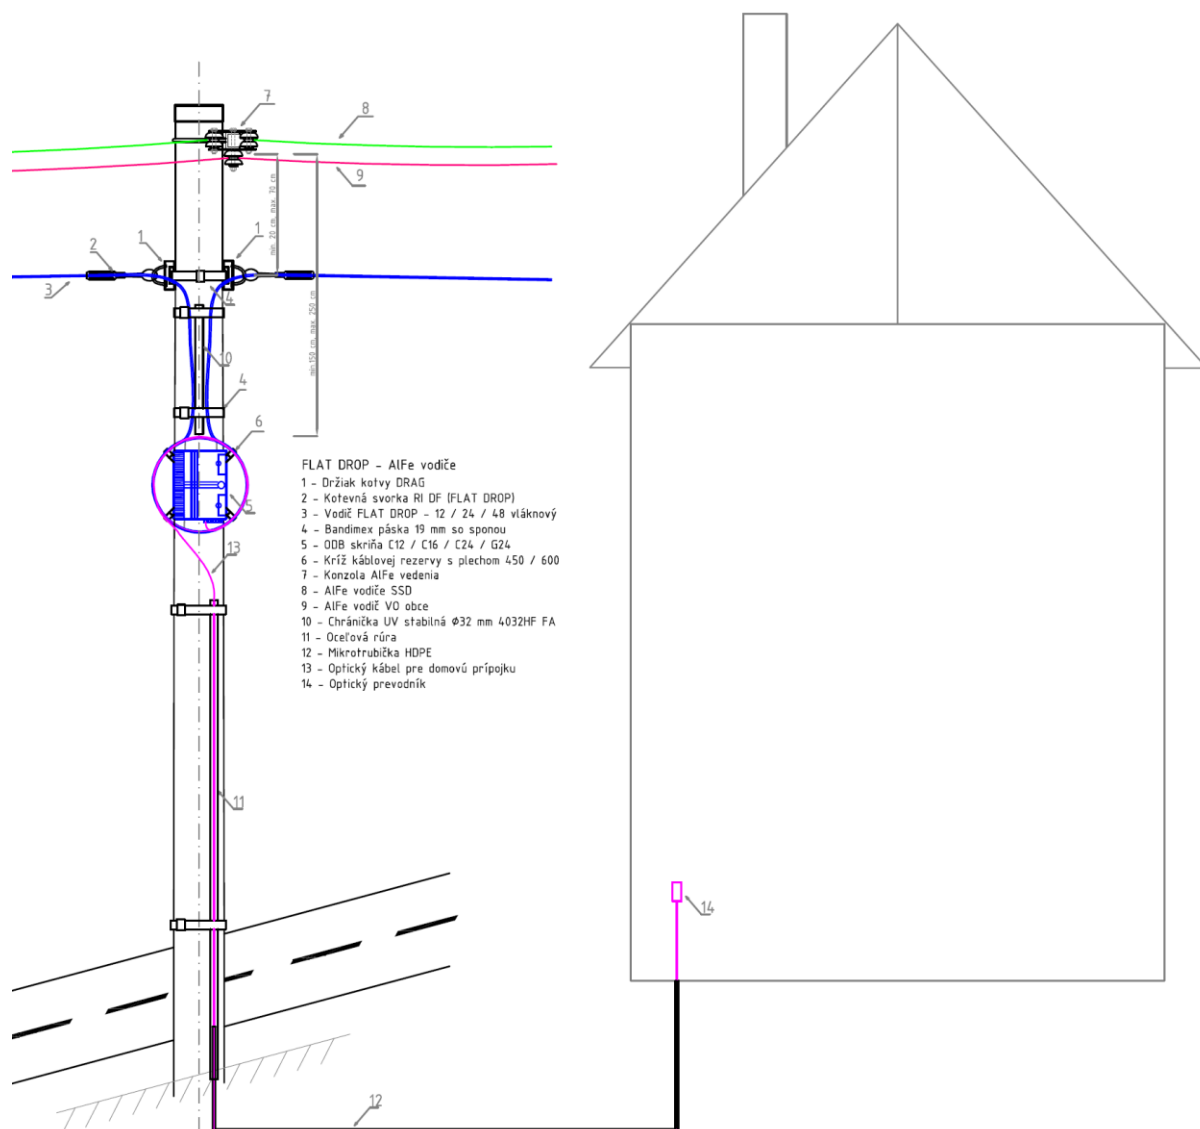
Príklad napojenia DOP, pohľad zo strany zástavby.
